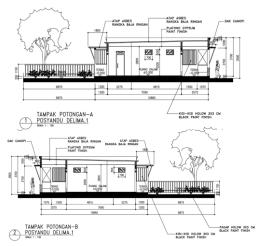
Usulan Pra Rencana Bangunan Pos Pelayanan Terpadu Delima (Tampak)
